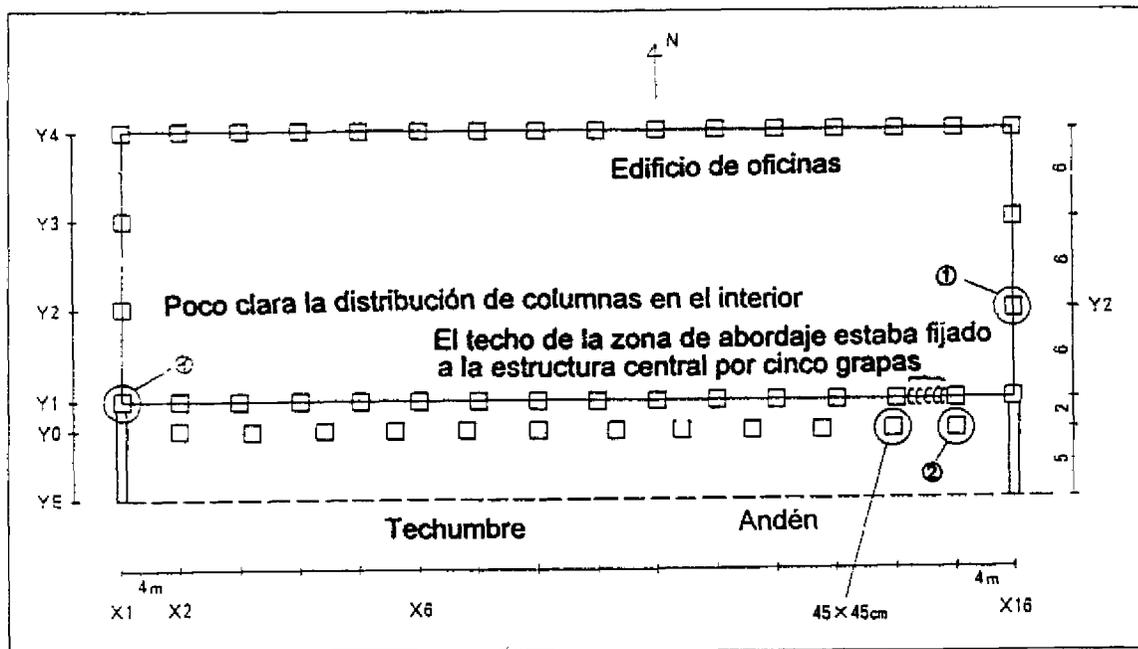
Vista en planta de las estructuras del cuerpo central y la techumbre
